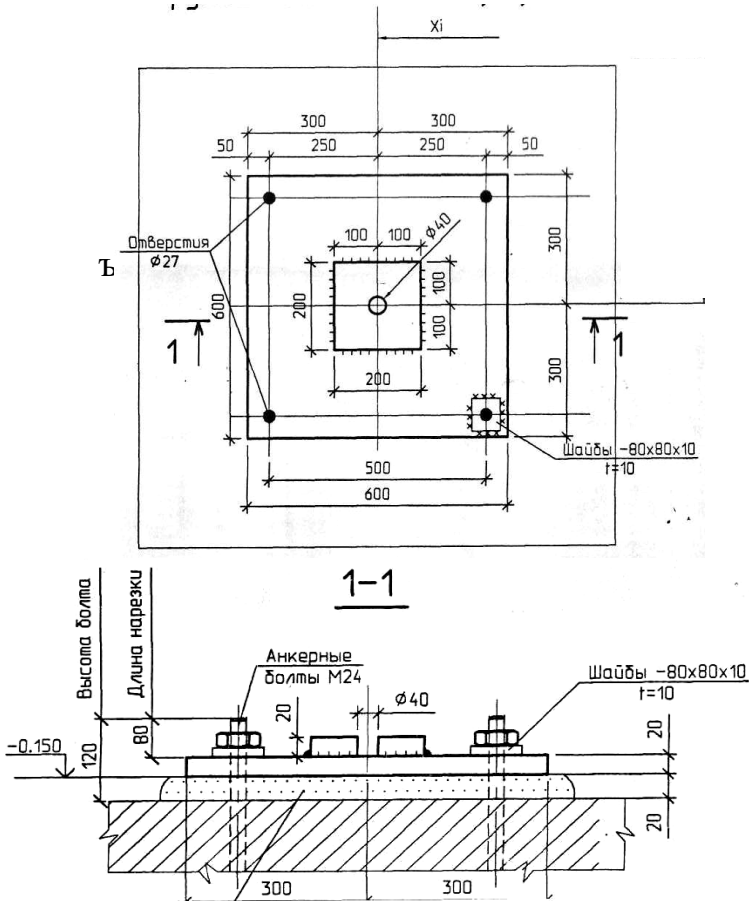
Установочна плита ФП 1 фундаменту типу 2,3,4
